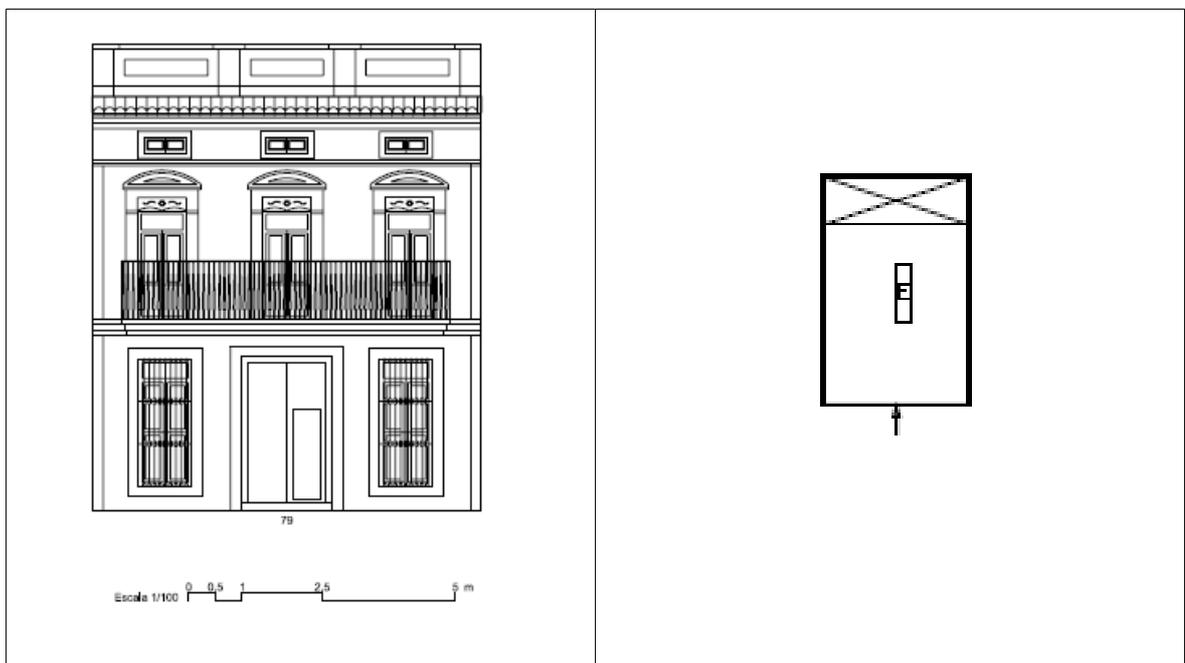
Tipo A22. Ejemplo de fachada y esquema de planta (ficha 313-16)
